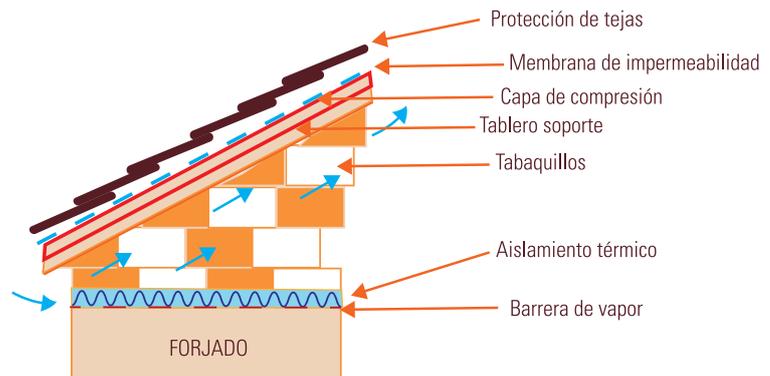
Cubierta fría con aislamiento sobre forjado
